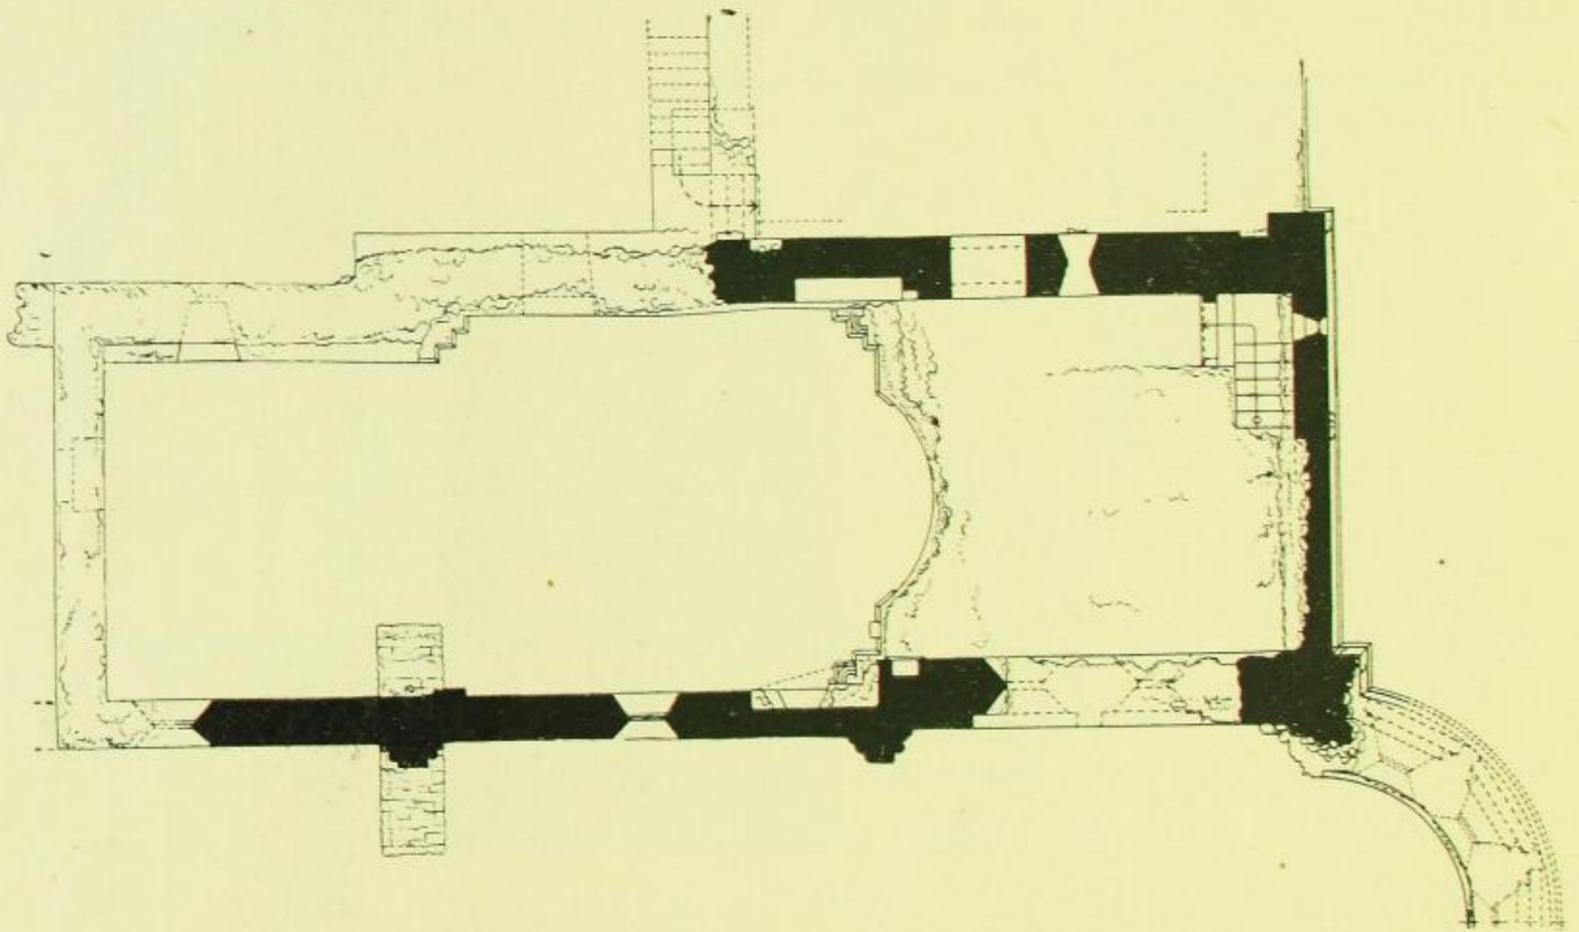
Kloster Heiligenkreuz, Querhaus, Grundriß des Nonnenchores.
